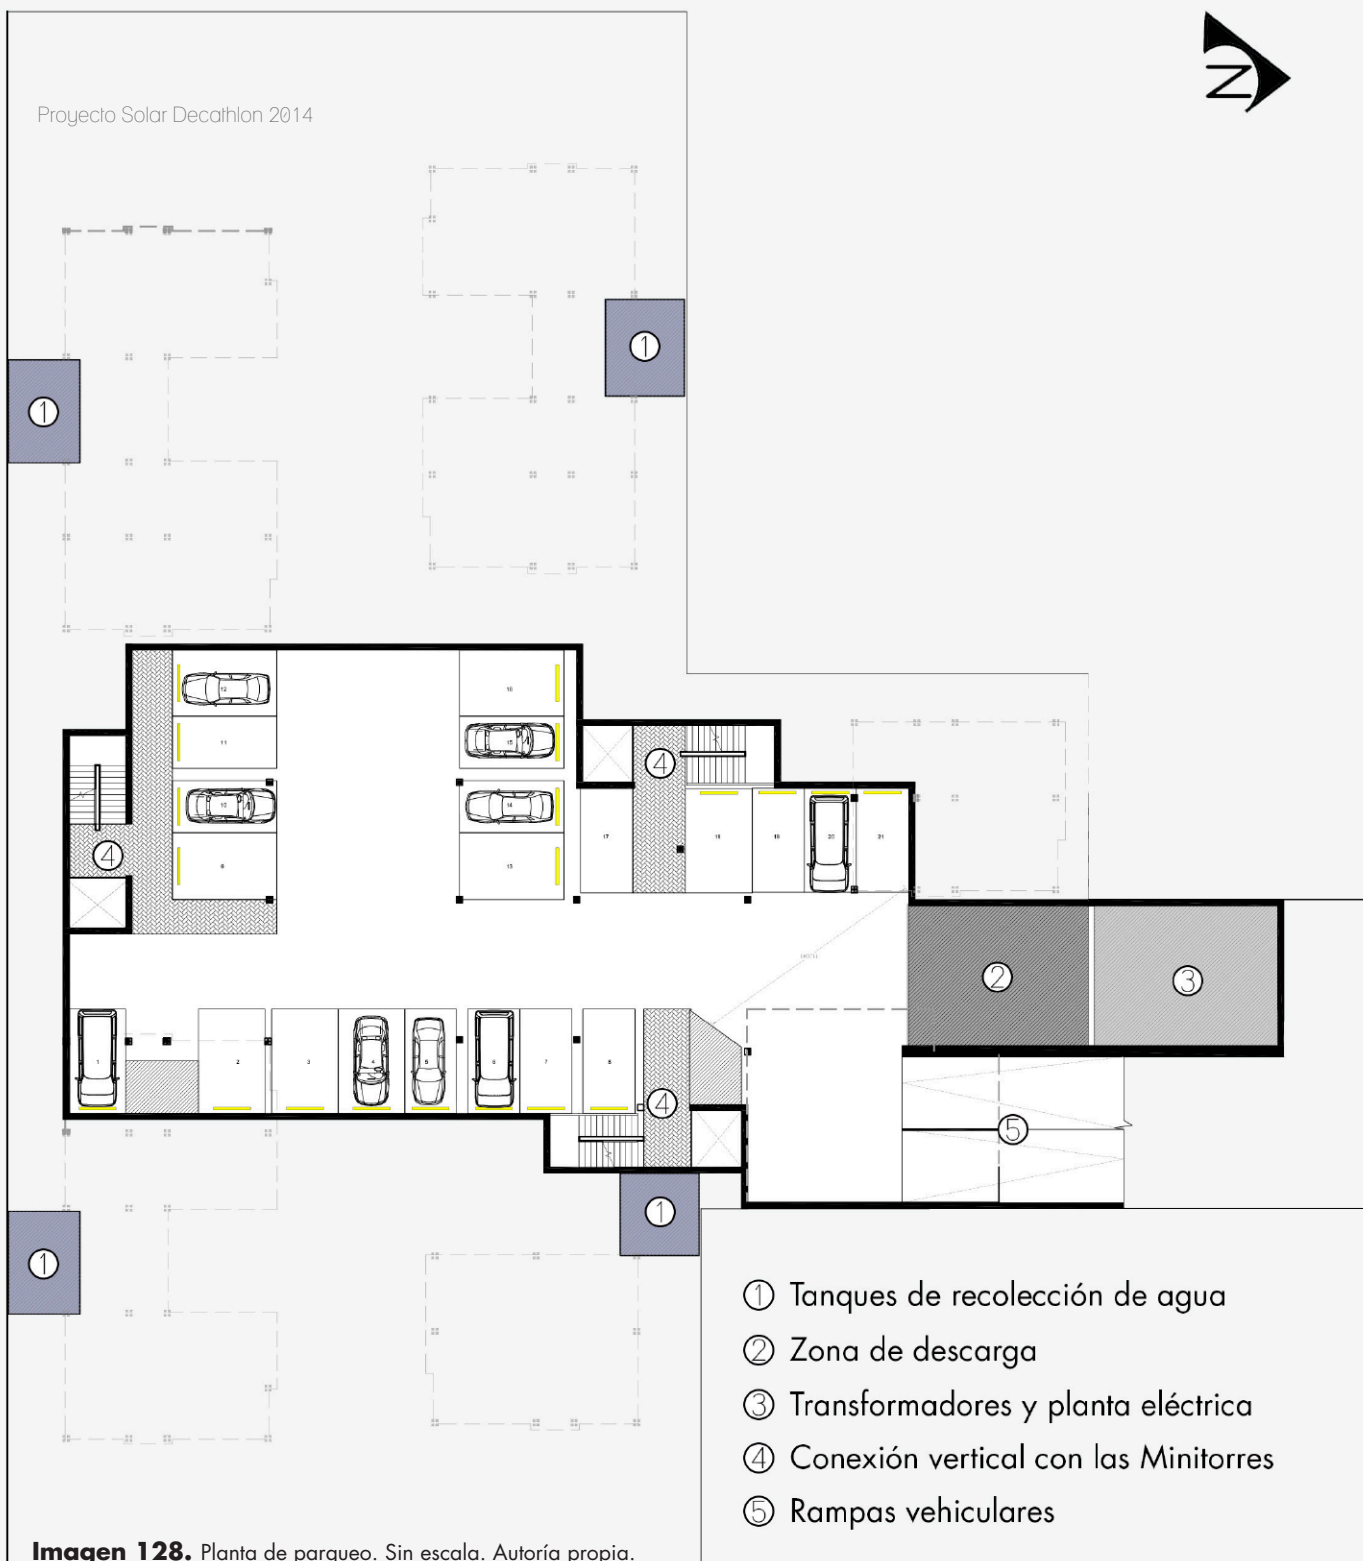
Planta de parqueo. Sin escala. Autoría propia.
